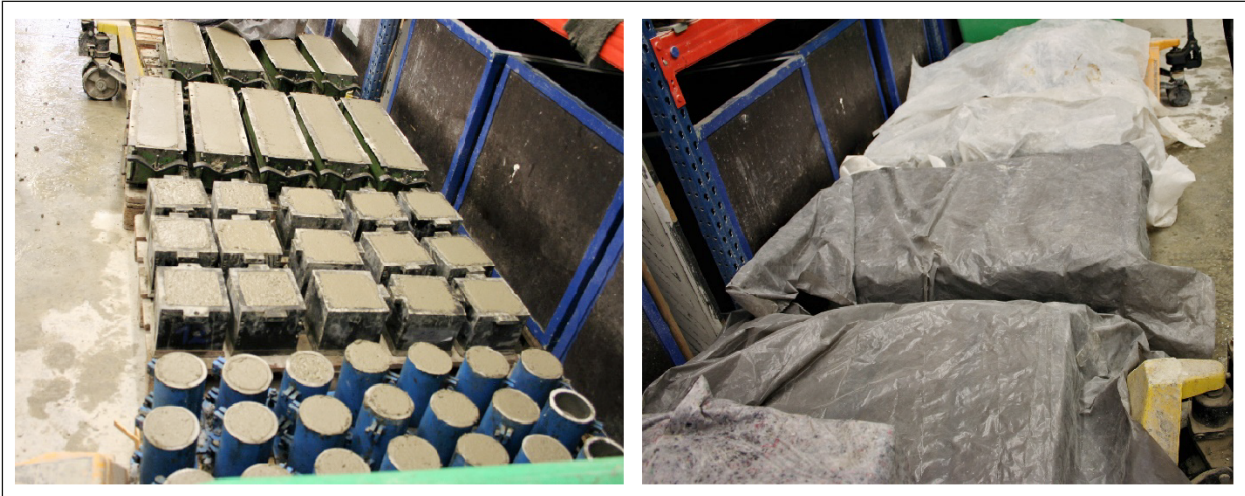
Mit Frischbeton einer Betonrezeptur gefüllte Schalungen (links); Lagerung der frisch hergestellten Probekörper bis zum Ausschaltzeitpunkt (rechts)
